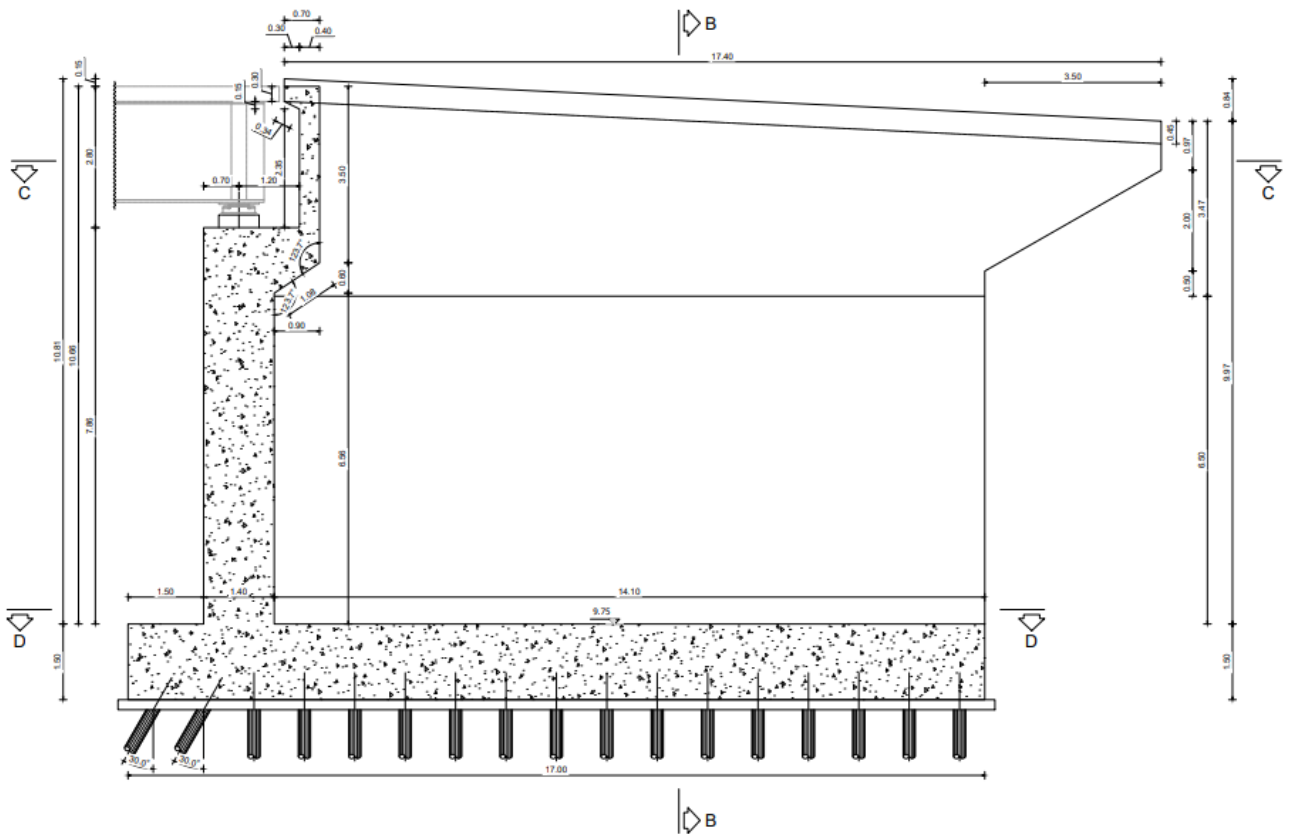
Sezione spalla "SP2" lato Rotatoria 2
